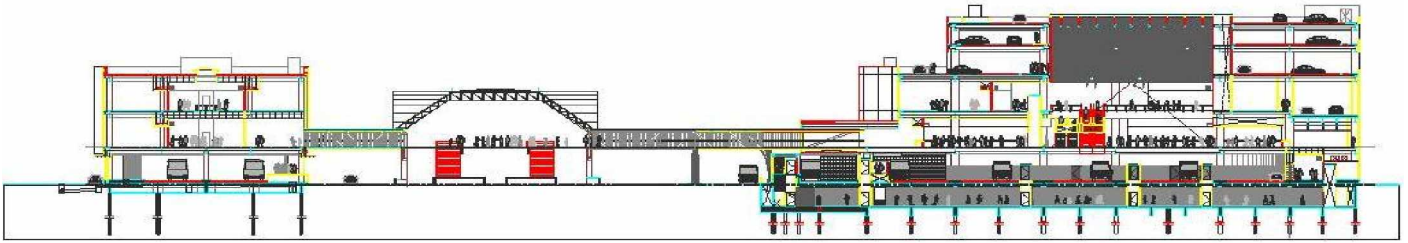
Corte de la sección transversal del CETRAM.
